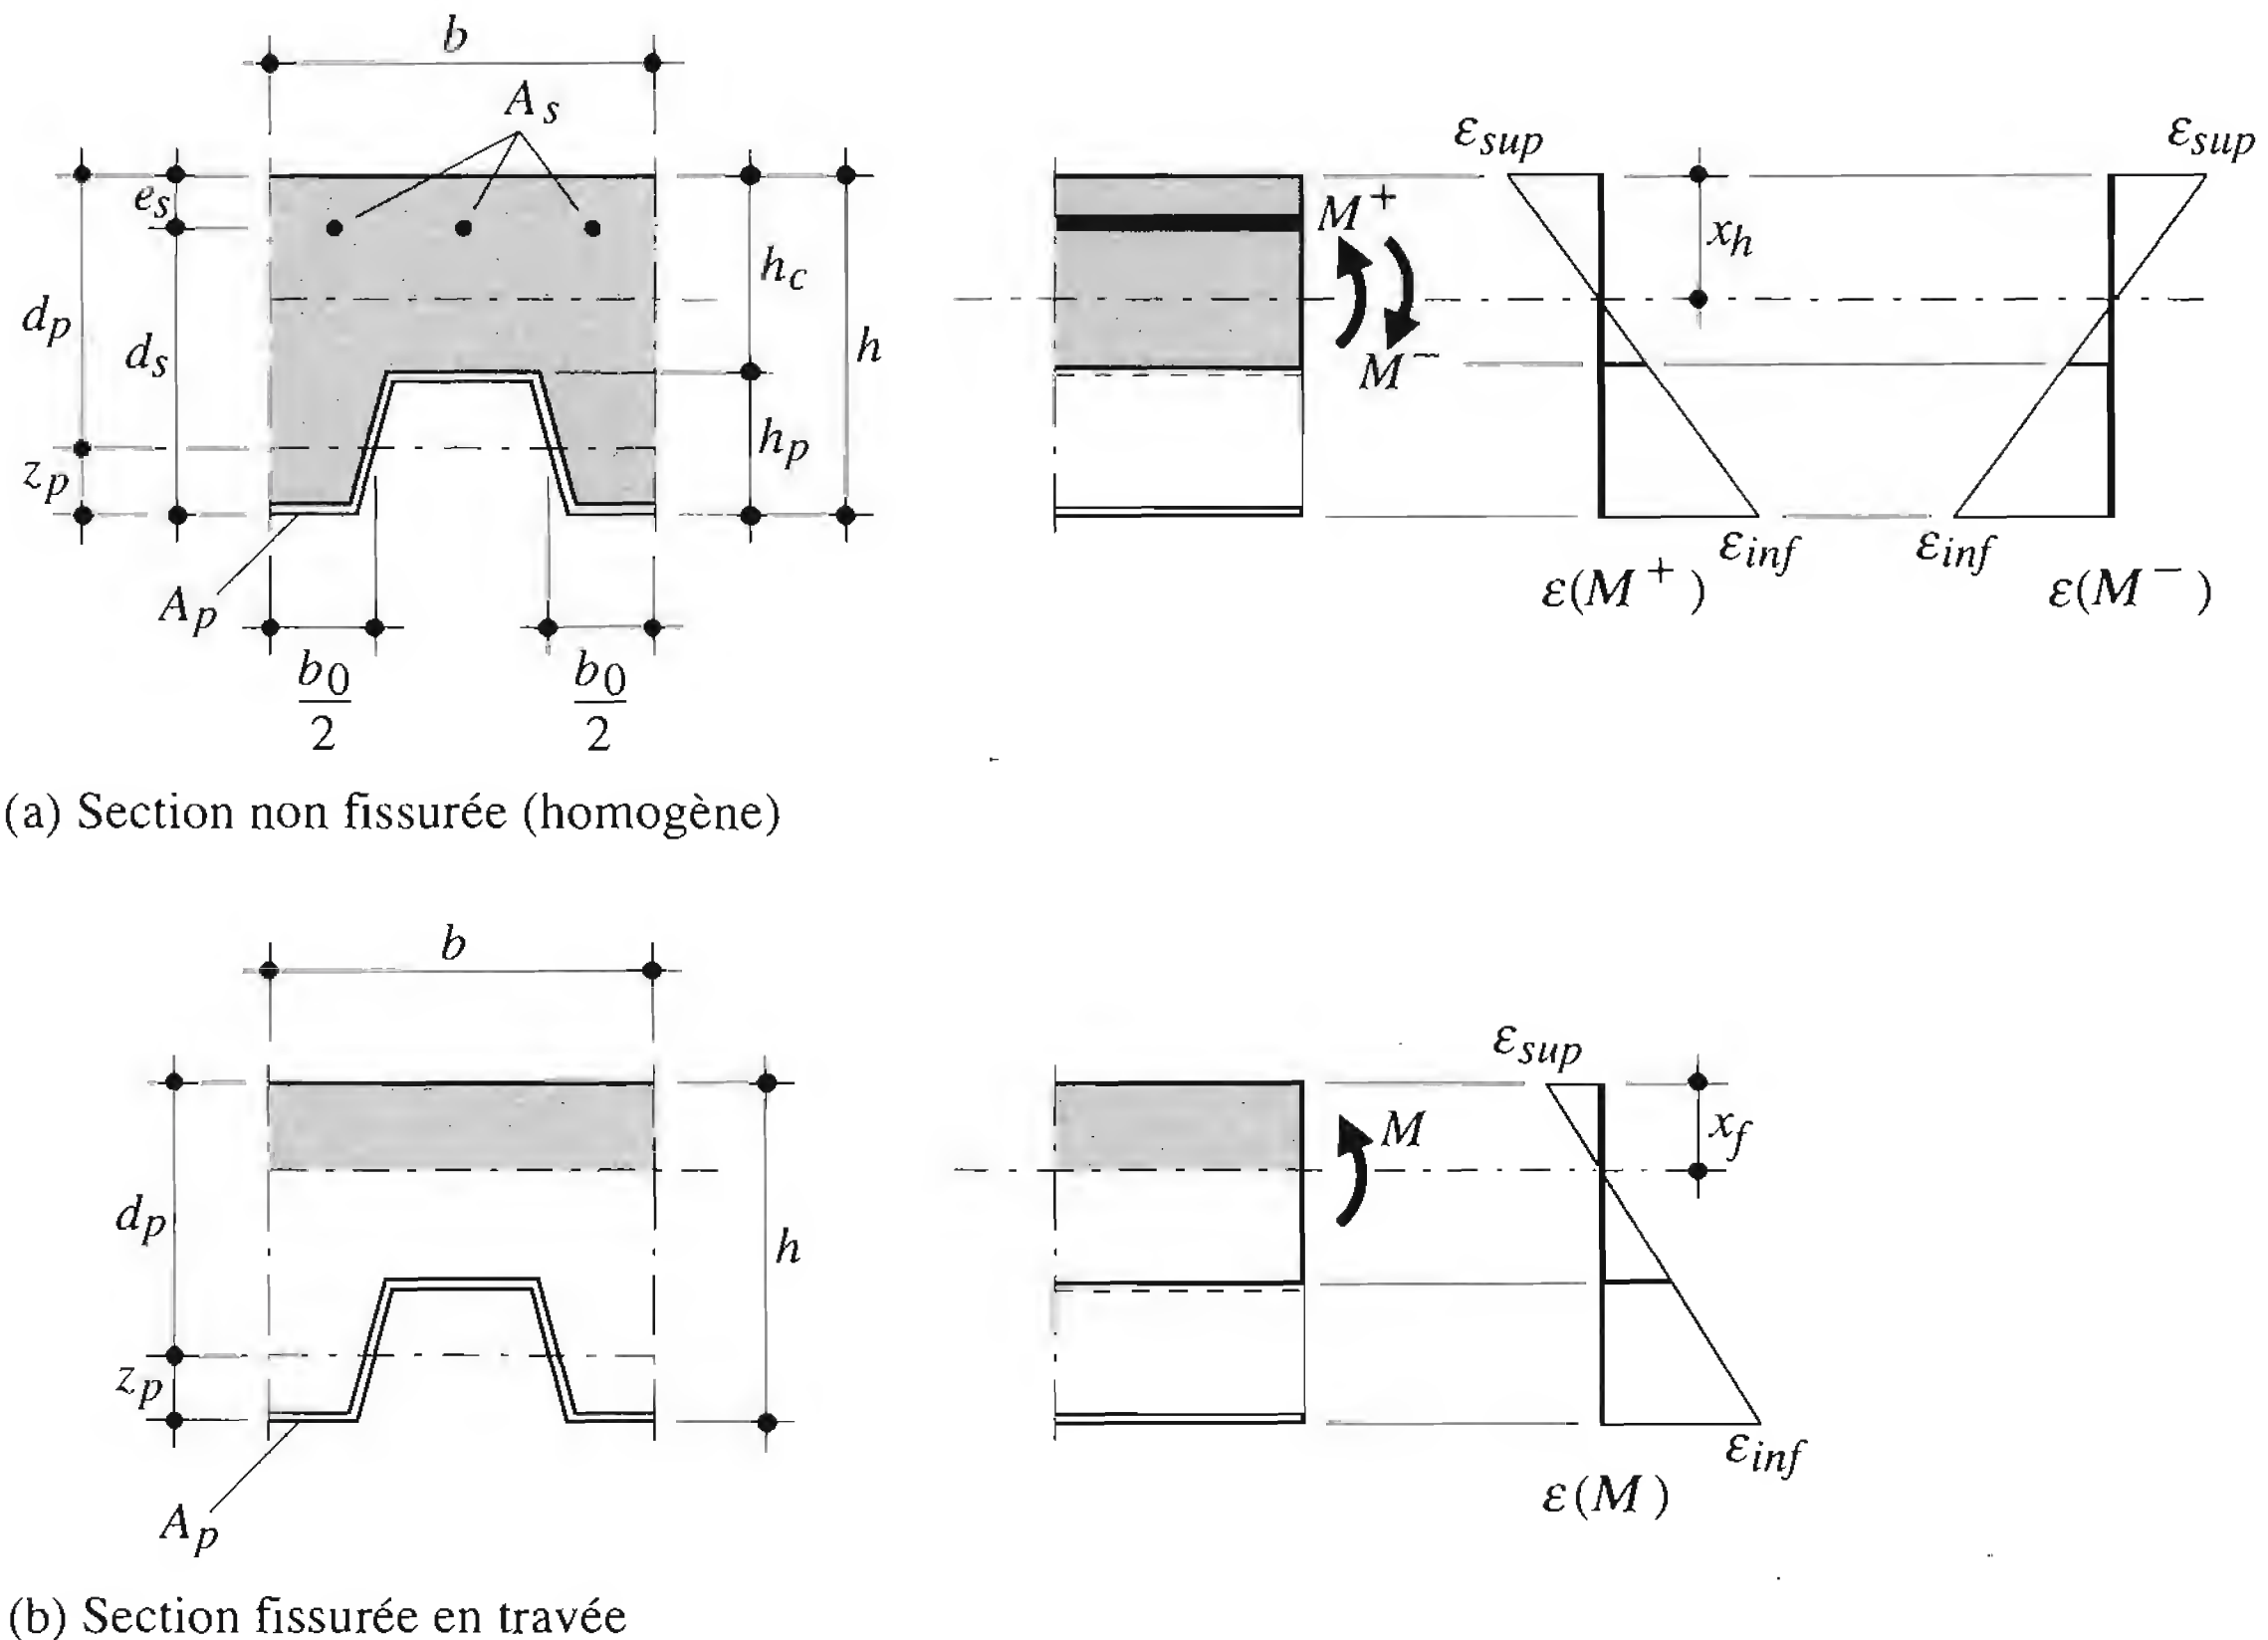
Sections de dalle mixte non fissurées et fissurées.
